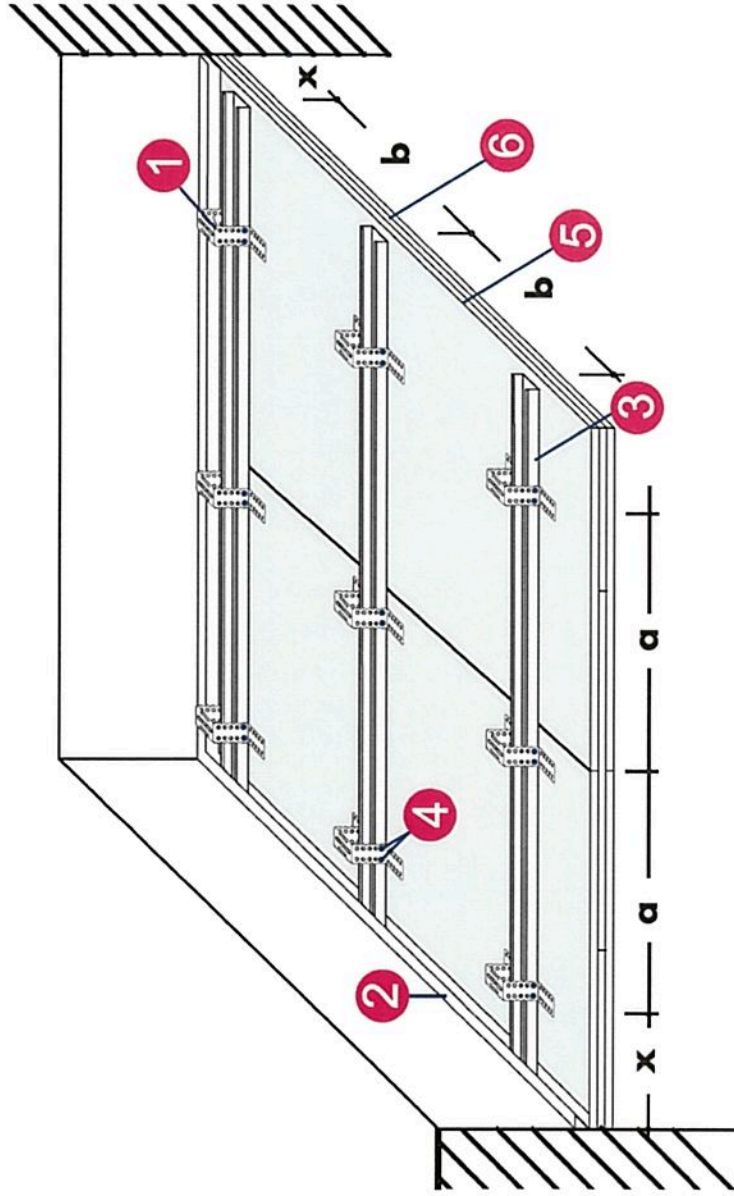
Widok sufitu podwieszanego – konstrukcja krzyżowa jednopoziomowa
